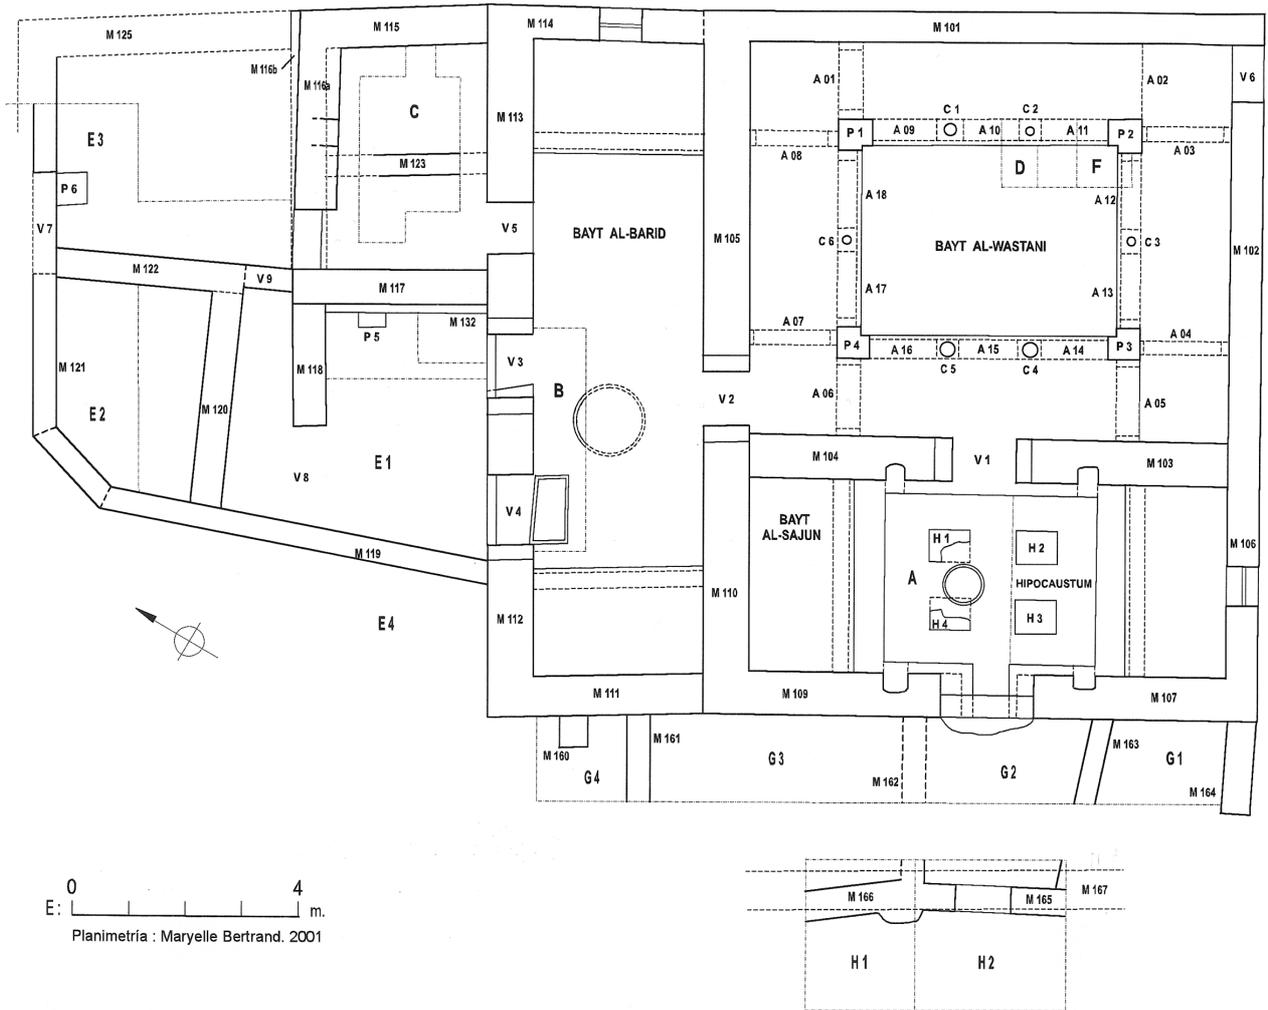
Planimetría del Baño Árabe, numeración de estructuras y localización de los sondeos.
